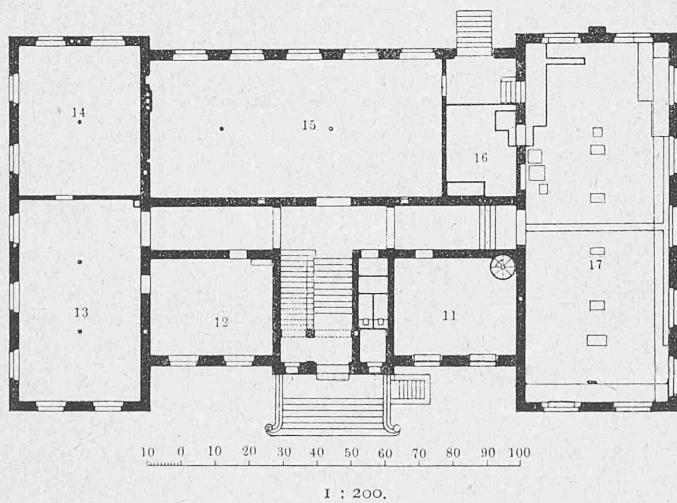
Grundriss vom Erdgeschoss.
